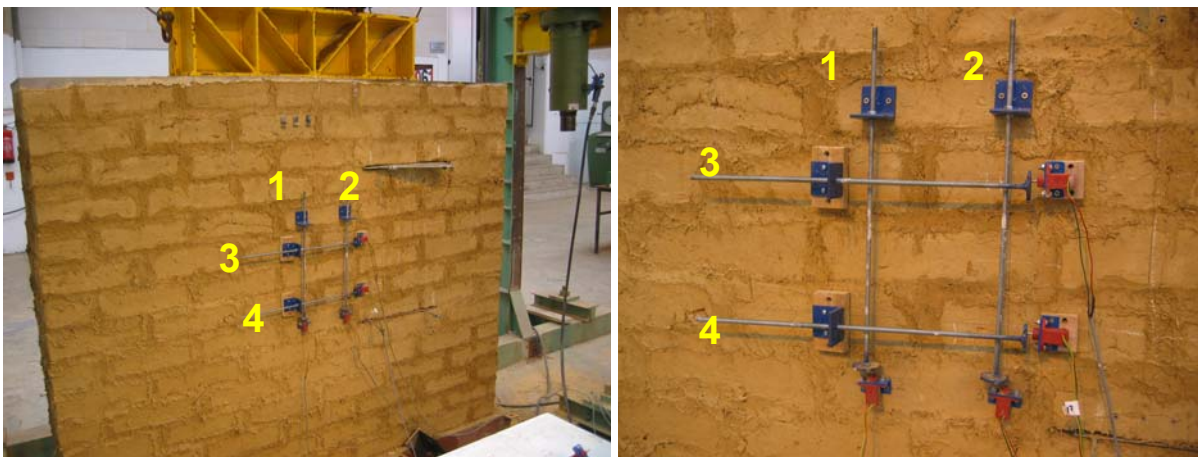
Ubicación de los transductores dentro del alzado del muro.
